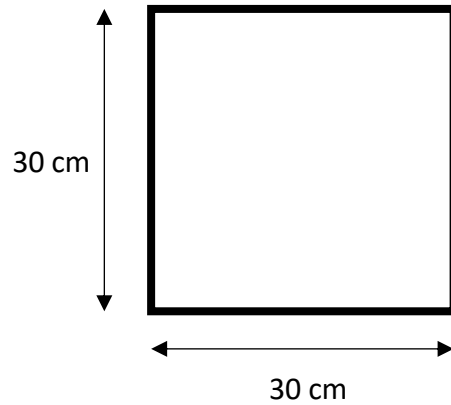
Dimension d'une Poutre Secondaire « PS »
